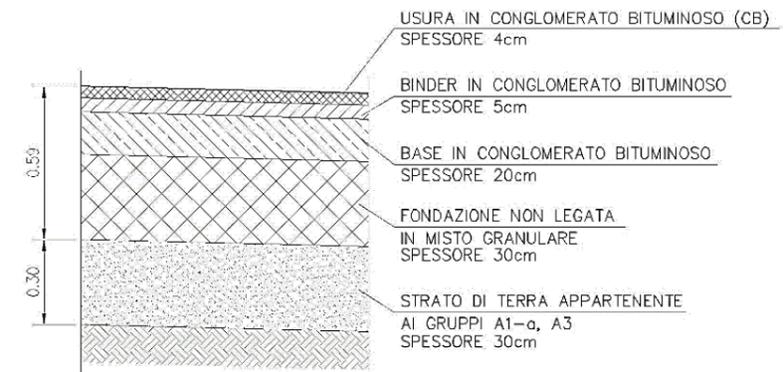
Dettaglio pavimentazione viabilità di accesso
